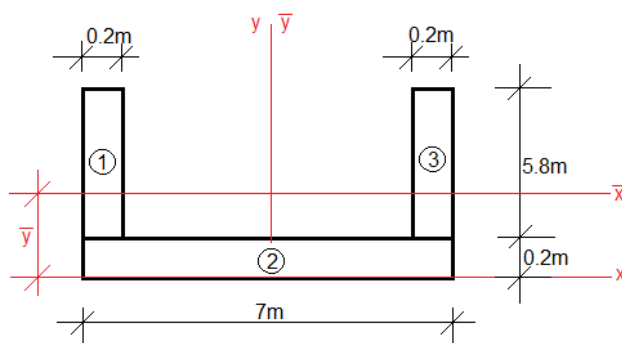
Divisão seção transversal NE para determinação do centroide e momentos de inércia.
